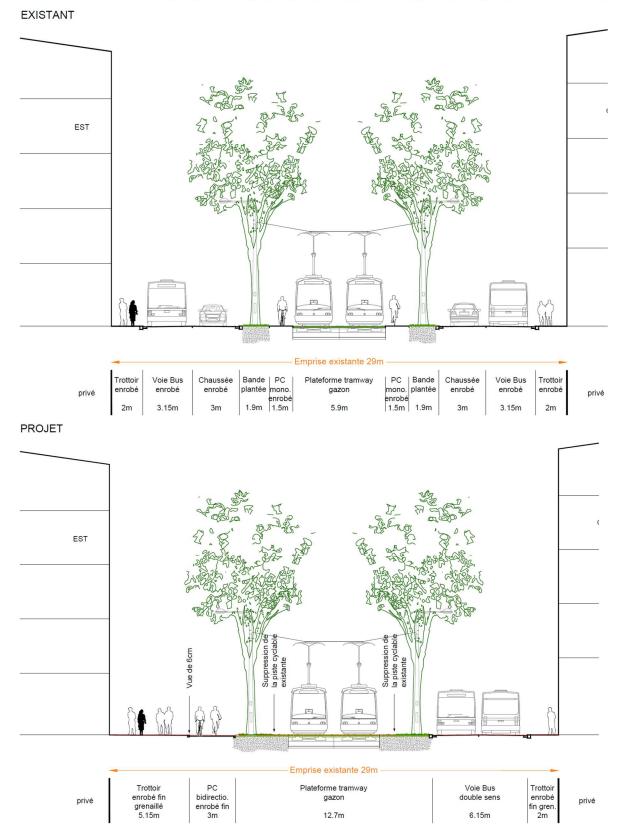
Coupe du boulevard Wilson sur la section entre Place de la gare et Fbg de Saverne (source : AVP GETAS, 2023)
